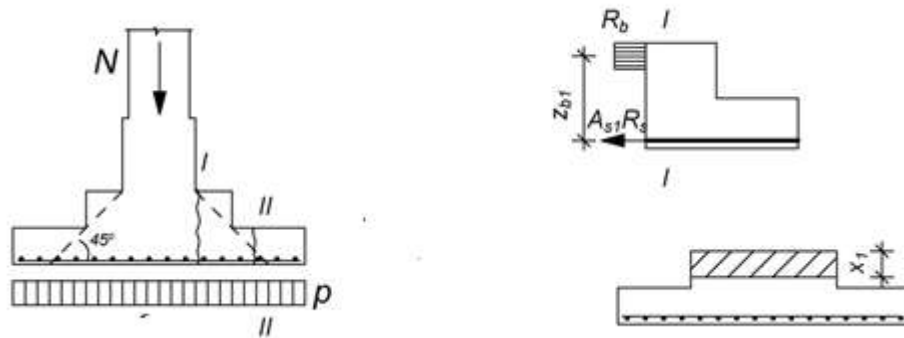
До розрахунку арматури підшви фундаменту
